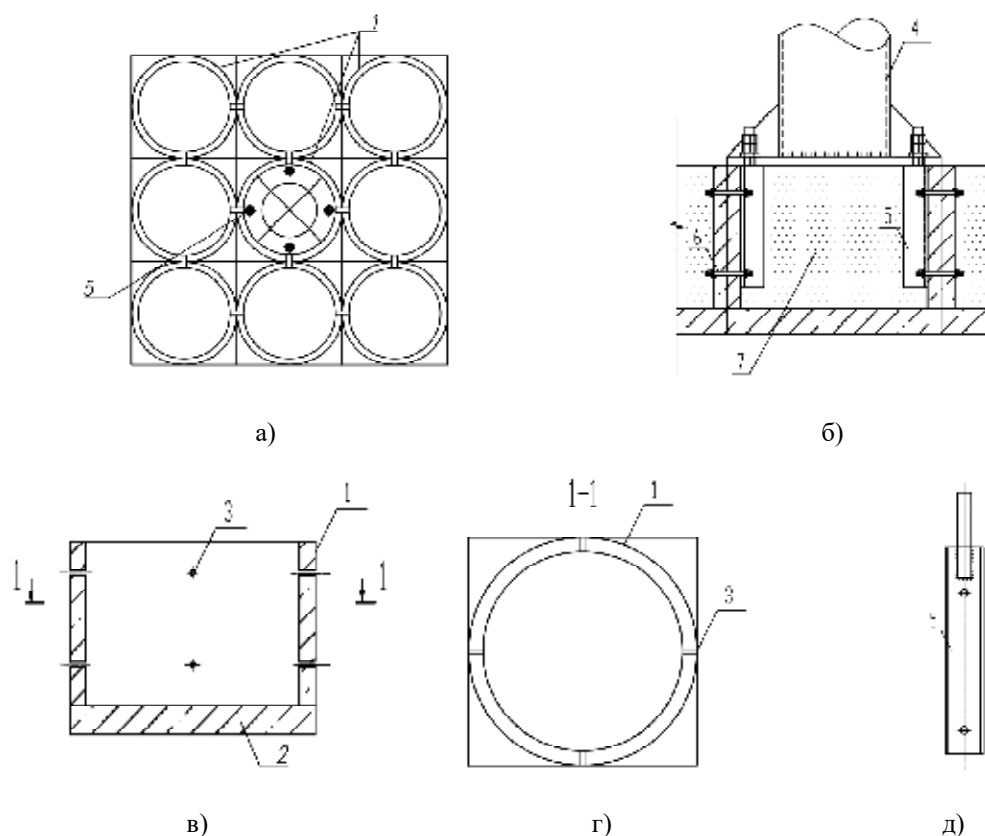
Конструкция сборно-разборного фундамента под опору: а – общий вид; б – деталь опоры; в – отдельный железобетонный блок; г – разрез 1-1; д – общий вид анкера; 1 – железобетонные элементы кругового очертания; 2 – нижние квадратные днище; 3 – отверстия для крепления; 4 – опора; 5 – анкер; 6 – крепёжные болты; 7 – заполнение инертным материалом [7]
